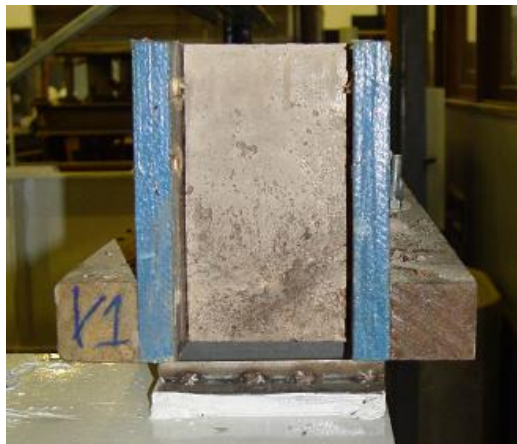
vista da extremidade da viga MC55-V1 apoiada diretamente no pórtico, antes da desforma do restante do elemento.
